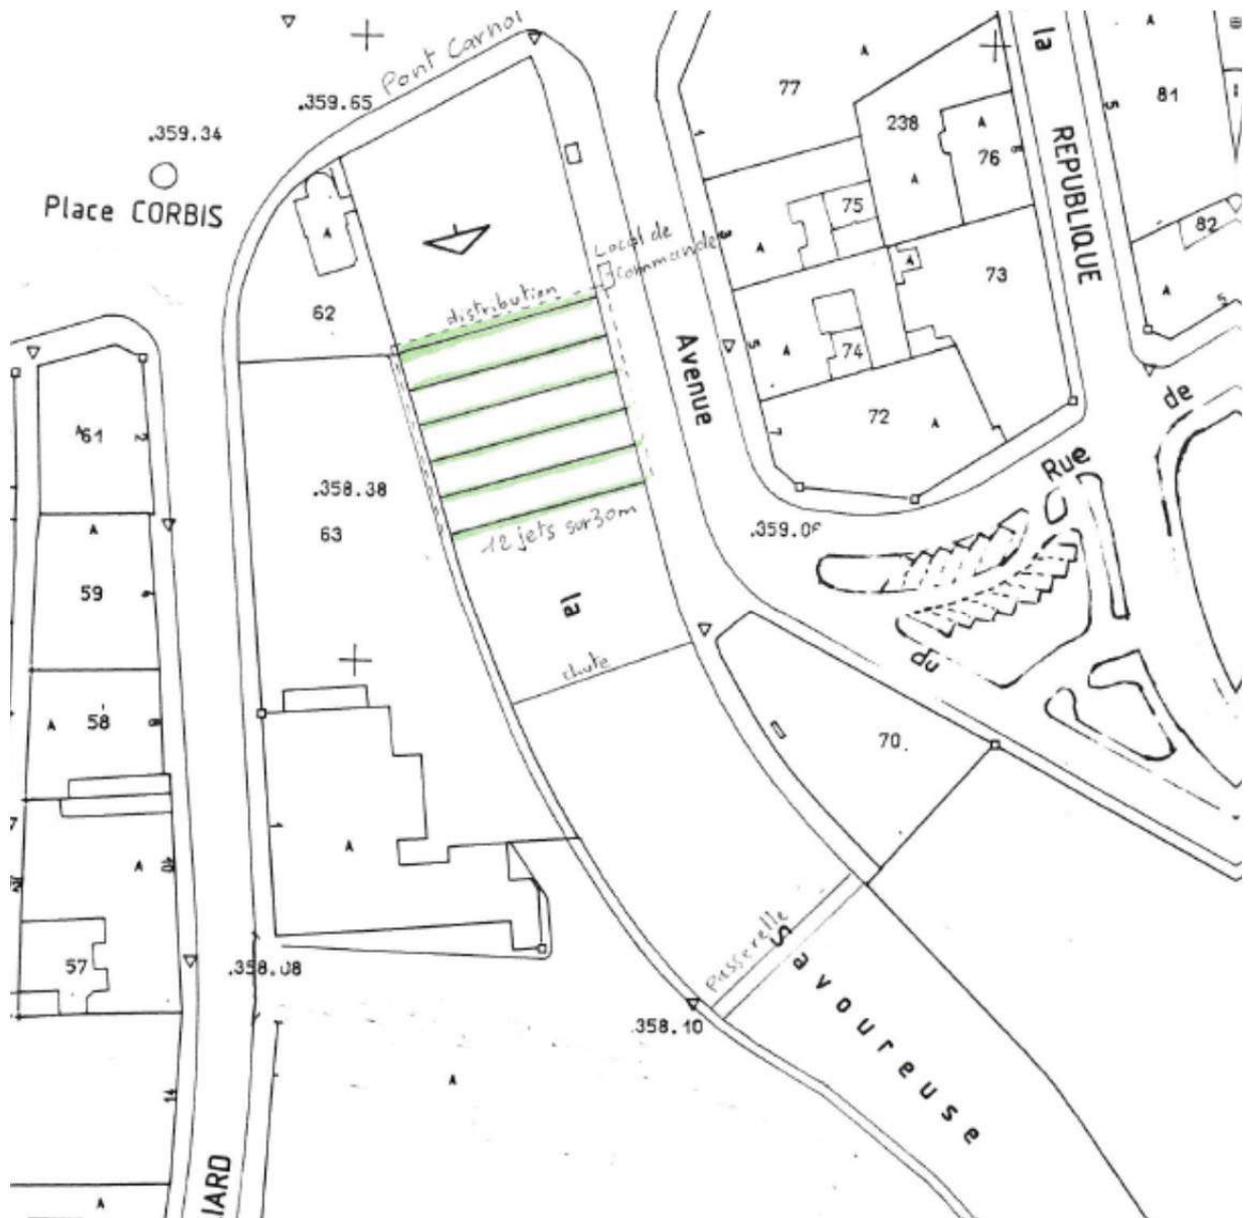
Plan d'alimentation du système de jets d'eau – extrait DOE Eau et Prestige
